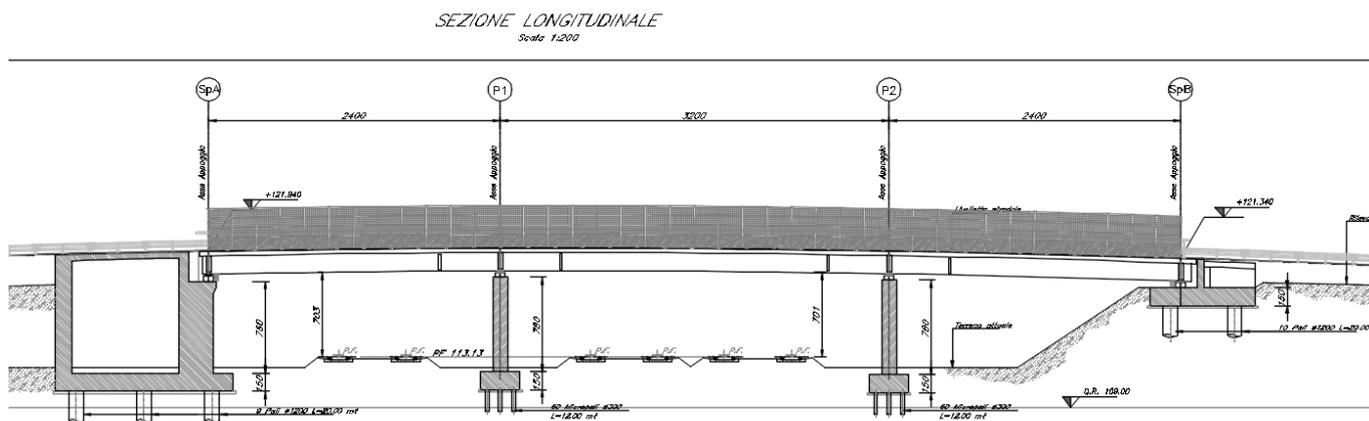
Sezione longitudinale nuovo cavalcaferrovia S.R.10
